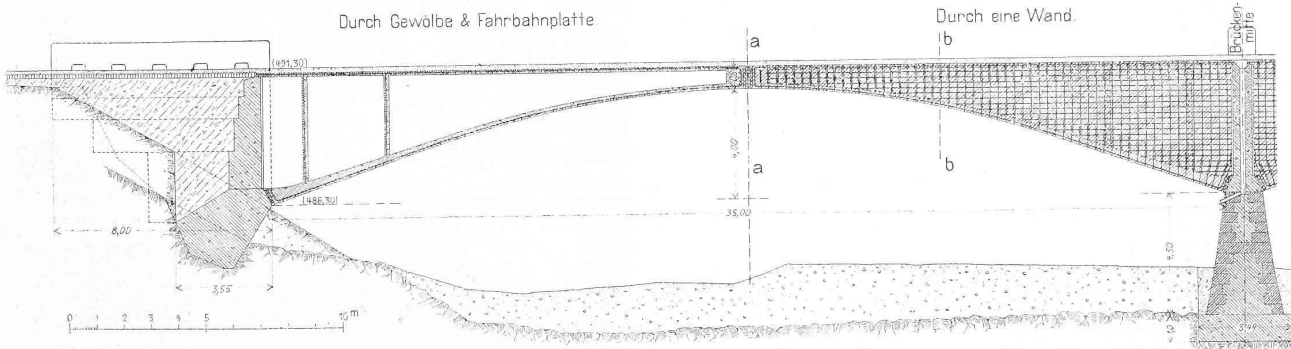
Längenschnitt einer Brückenöffnung mit den Eiseneinlagen. — Masstab 1 : 250.
